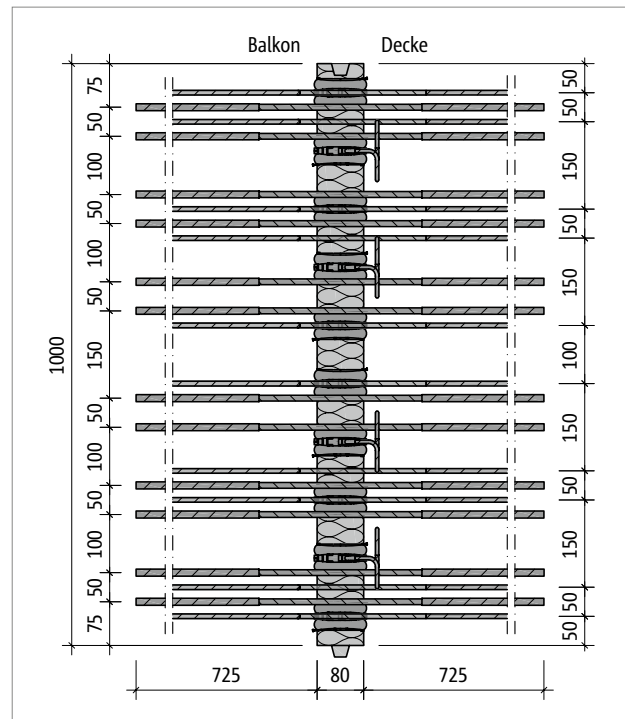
Schöck Isokorb® T Typ KL-M10-V2: Produktgrundriss
